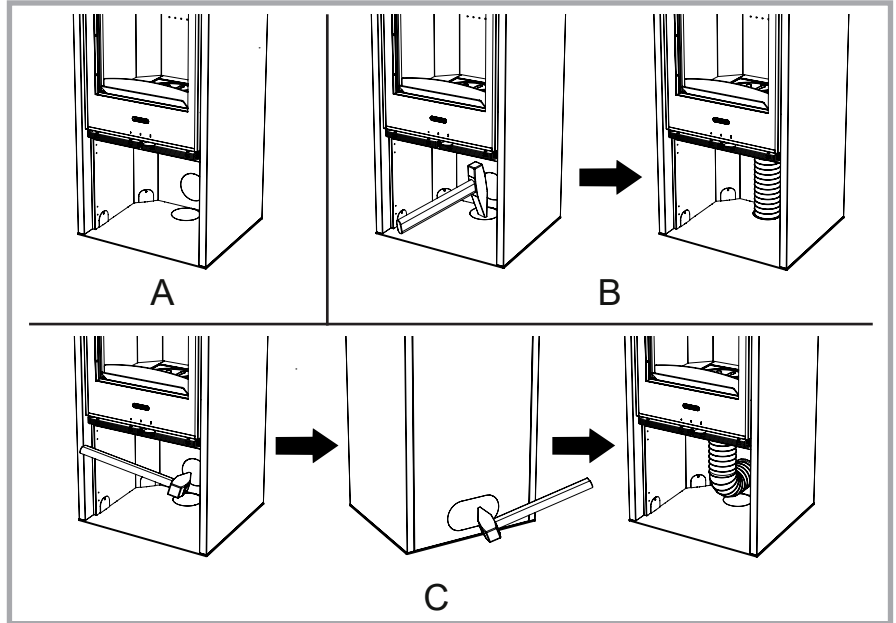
Modi di collegamento della presa d'aria della stufa a legna. A= Presa aria esterna non collegata B= Presa aria esterna a pavimento C= Presa aria esterna a parete.
